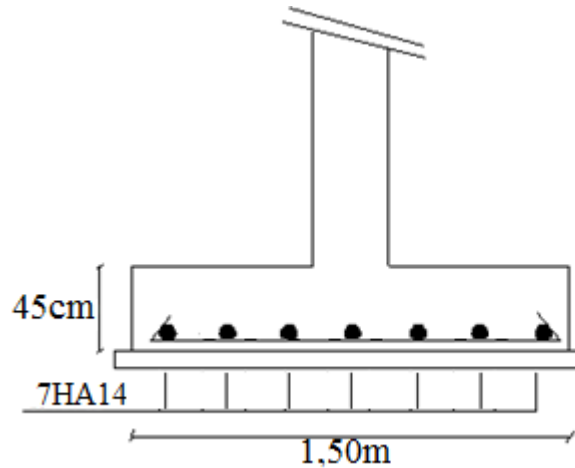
Ferrailage de la semelle jumelé dans le sens y-y.
